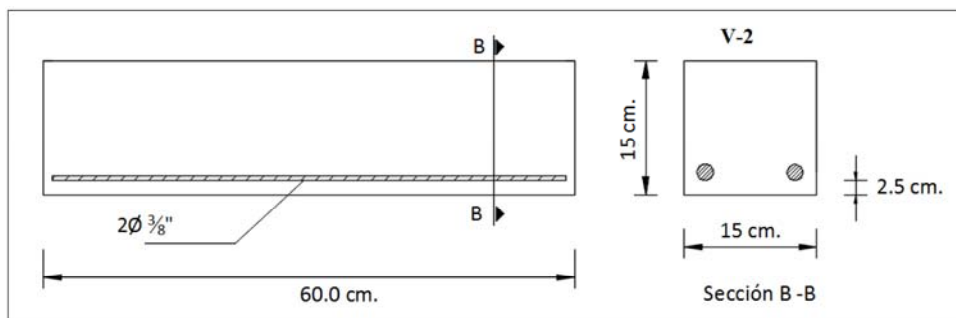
Viga con refuerzo de varilla de acero de 3/8" sin estribos (cuantía 0.82%)
